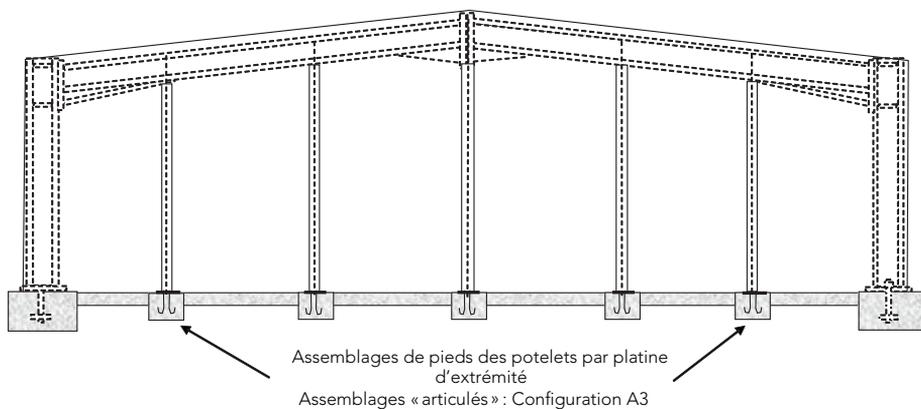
Assemblages en pieds des potelets d'un mur pignon d'un bâtiment industriel.
